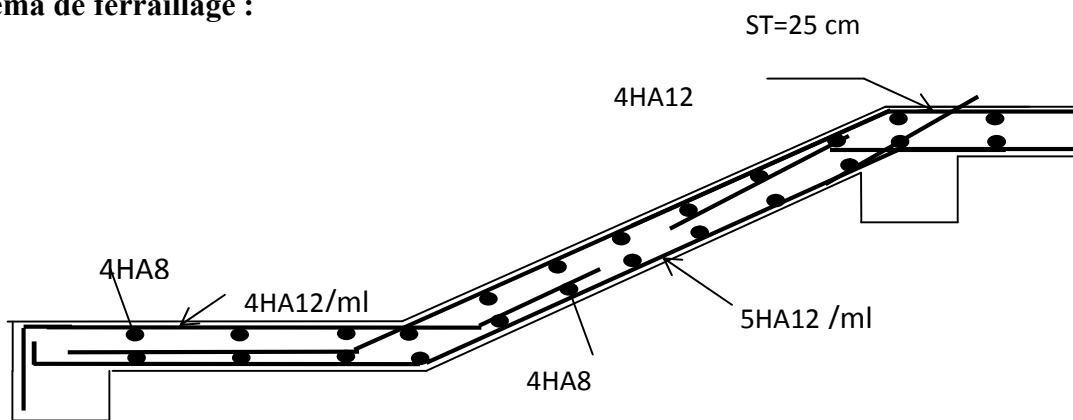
Schéma de ferrailage d'escalier type 1.
